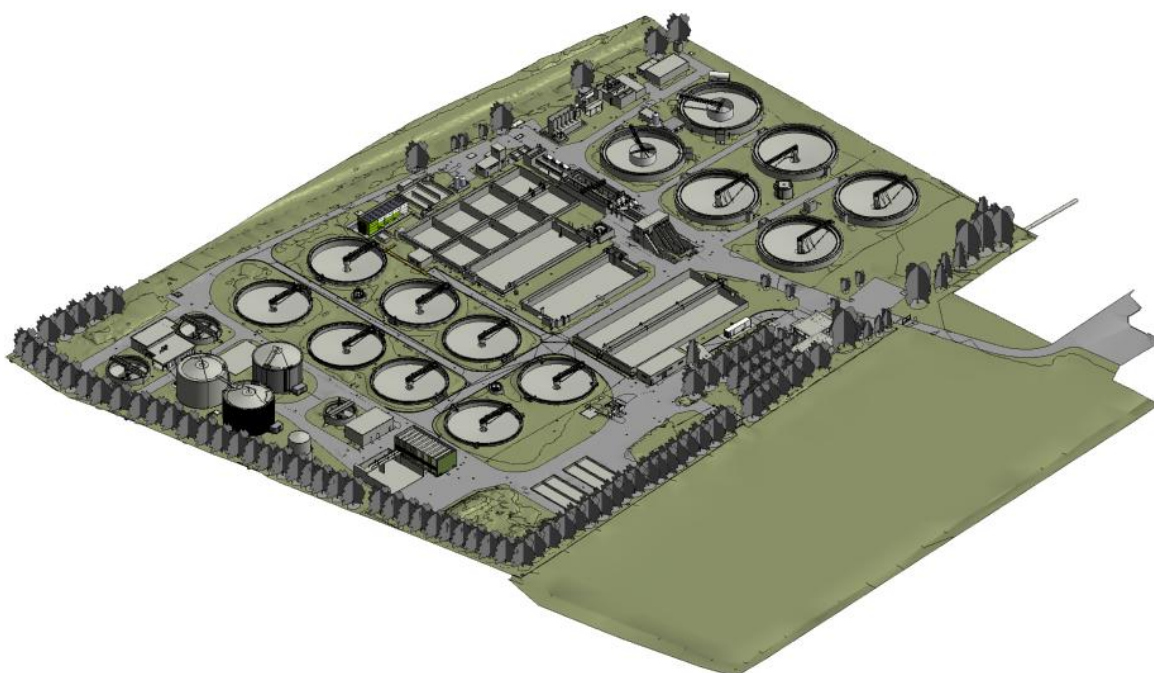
Modello tridimensionale stato di fatto impianto di depurazione di Ravenna
